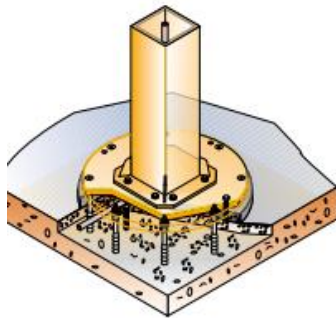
Esquema placa intermedia sobre forjado de hormigón
